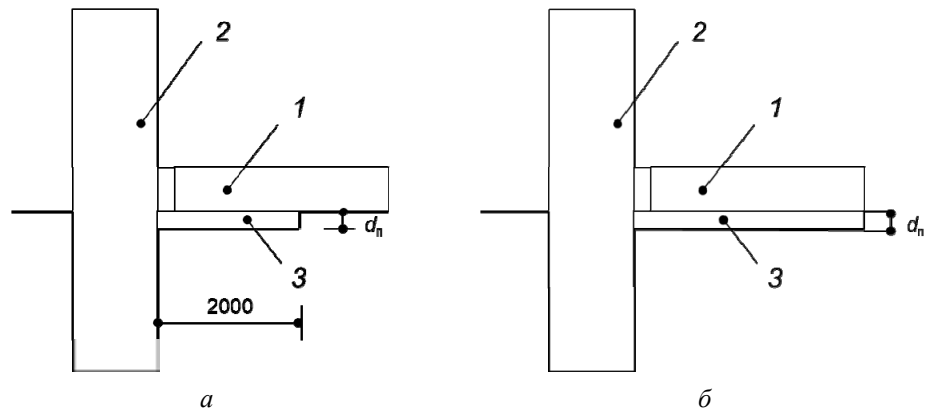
Схемы теплоизоляции краевой зоны плиты пола (а) и всей плиты пола (б): 1 — плита пола; 2 — стена фундамента; 3 — утеплитель; d_n — толщина изоляции
